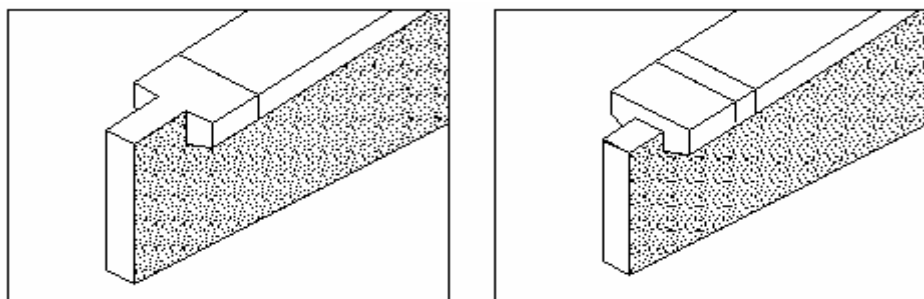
Recorte aleta (izquierda) y recorte canal (derecha)
